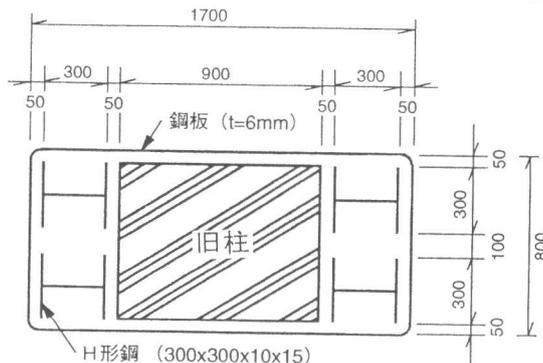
ランクⅠ、Ⅱ柱本復旧断面図
